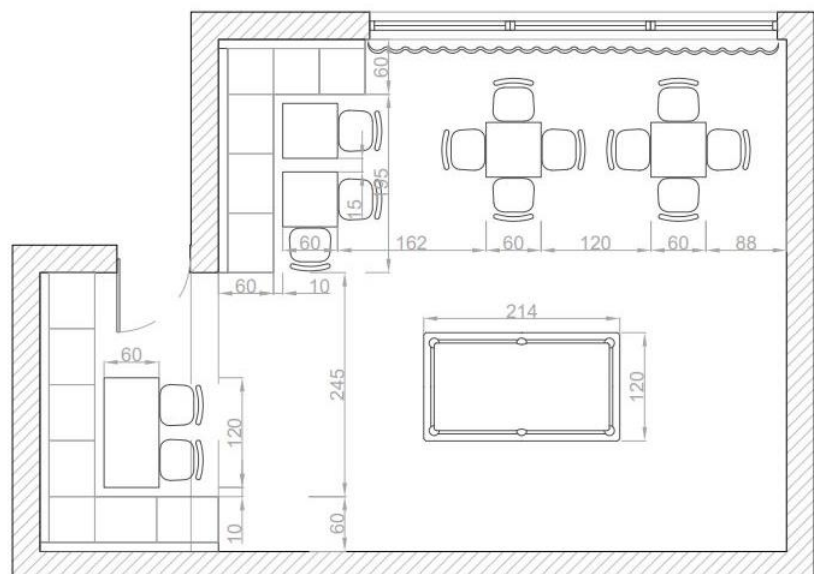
Planta de Equipamento Cotada da Cafeteria
